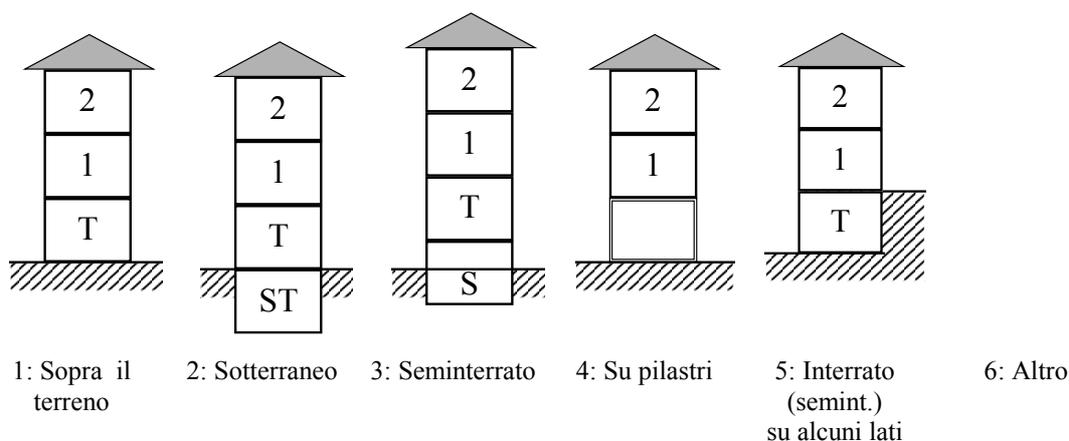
Posizioni rispetto al suolo del piano più basso dell'edificio
